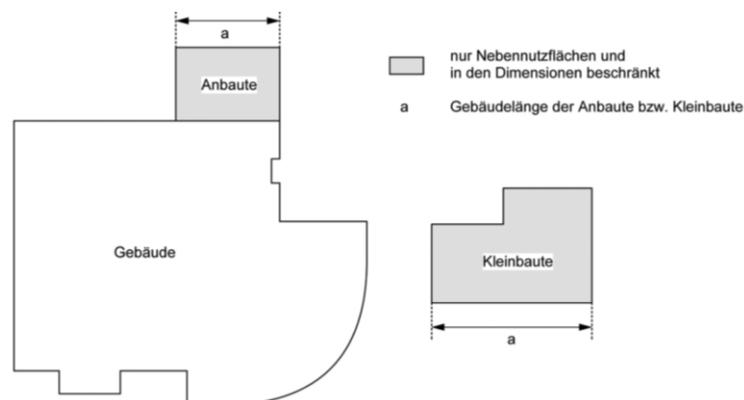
Schema Gebäude, Klein- und Anbauten gemäss §§ 2a ABV
